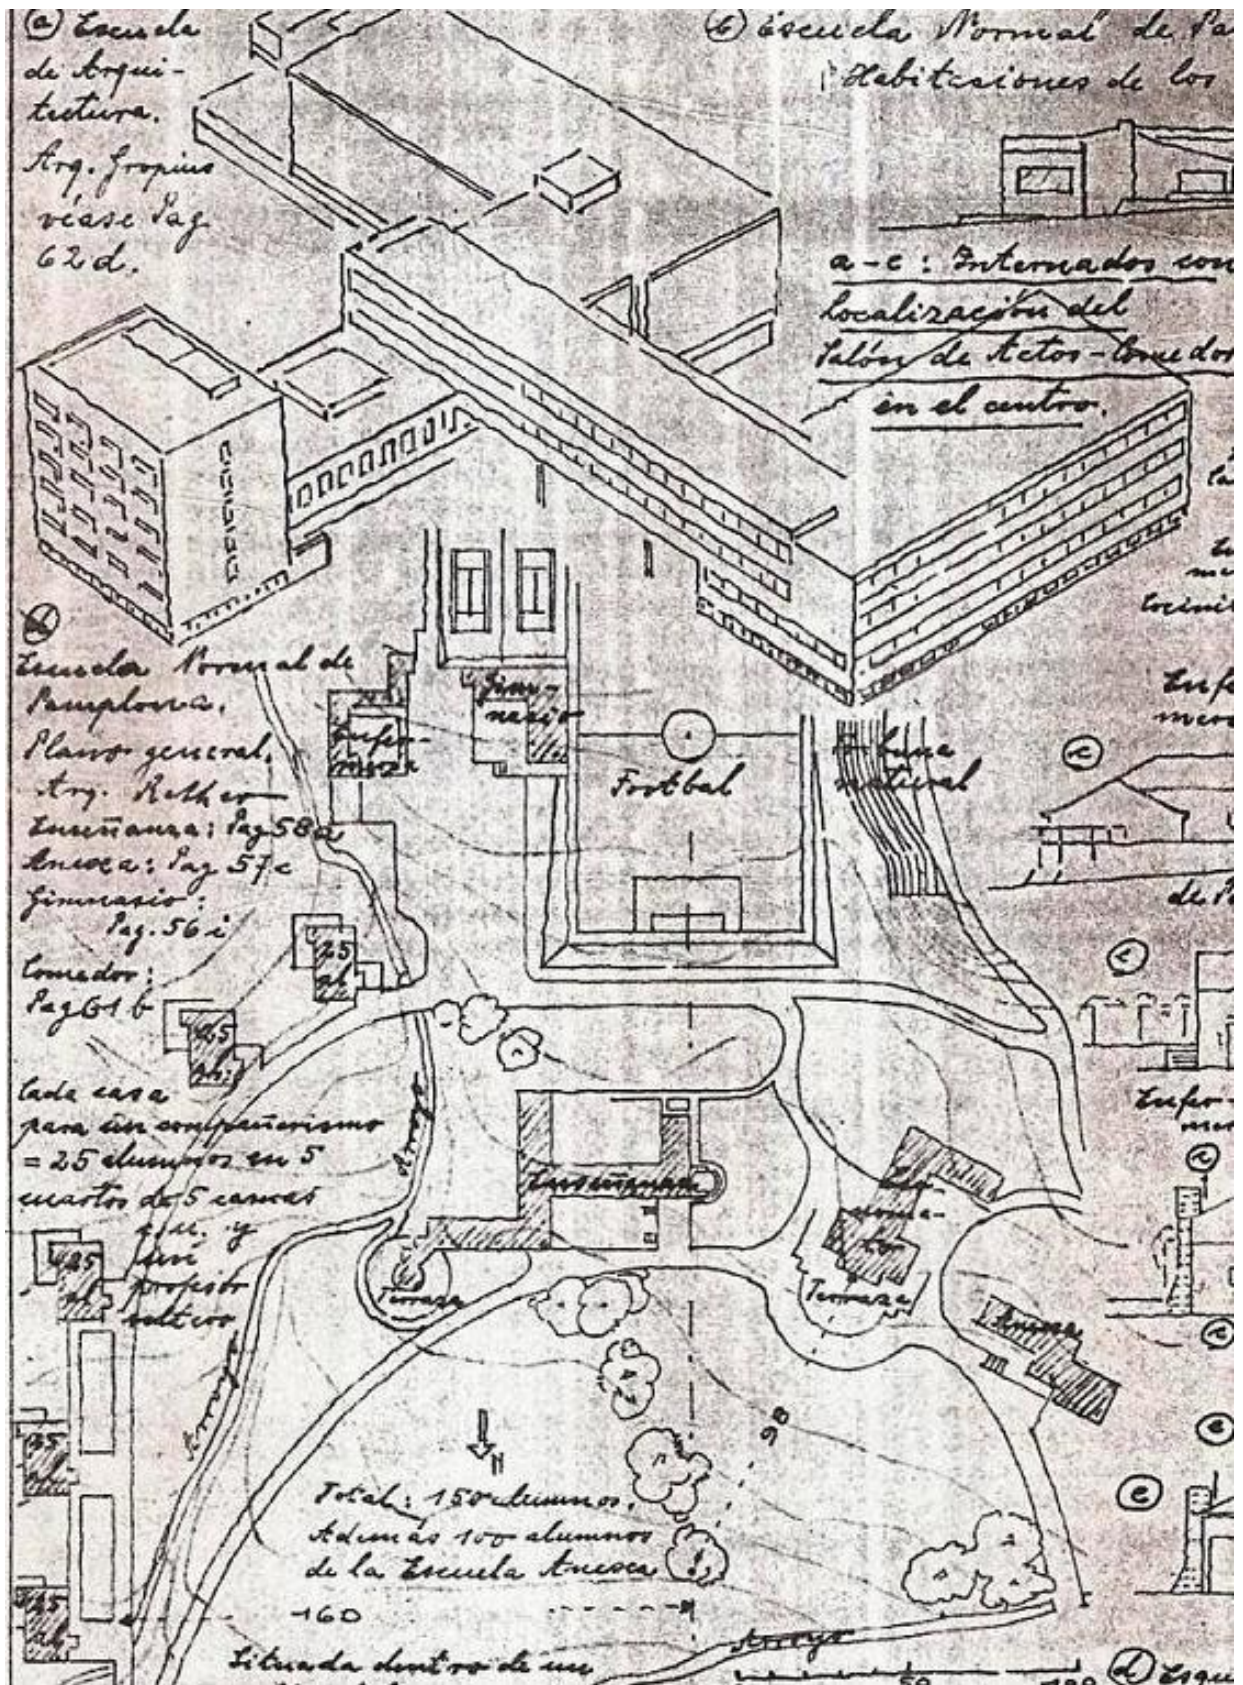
Ausschnitt aus der 63. Vorlesung mit Perspektive des Bauhausgebäudes in Dessau von Walter Gropius und Grundriss der Normalschule in Pamplona.
